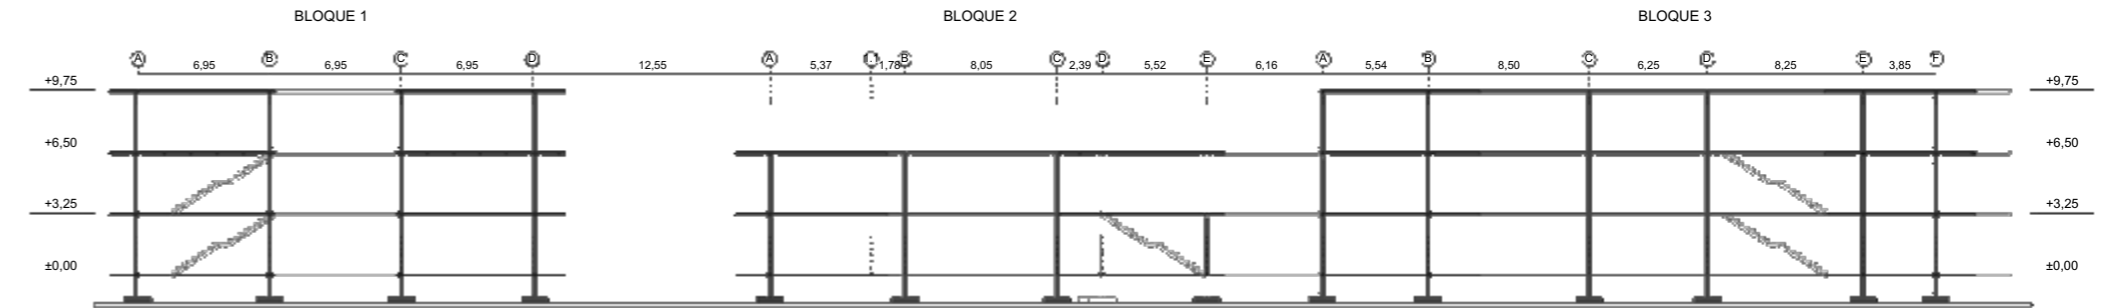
Diagrama de sección longitudinal del proyecto. Nota. Elaboración propia
